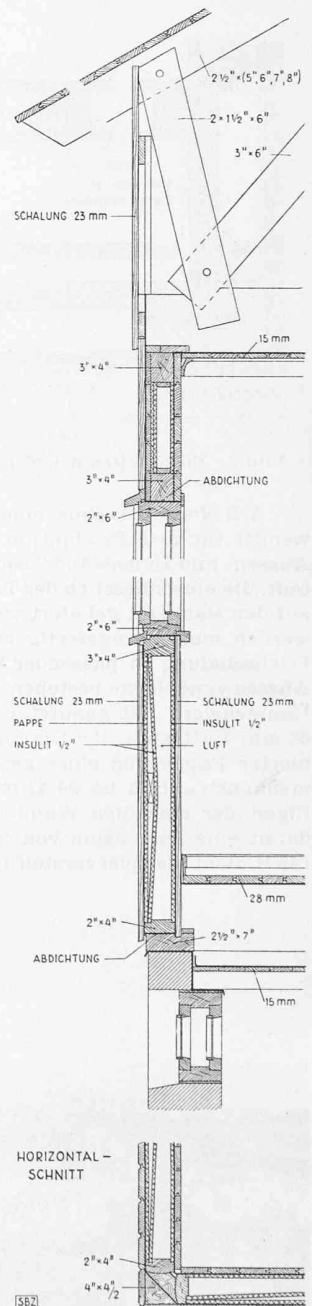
Konstruktion des Hauses Bild 1, Masstab 1:25
